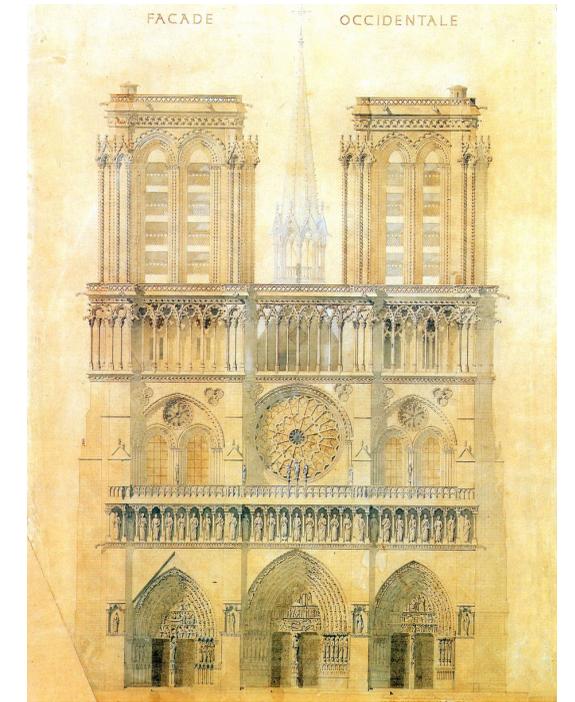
Proyecto de restauración de la fachada oeste de la catedral de Notre Dame en París con la reconstrucción de la aguja en el cruce, 1843.
